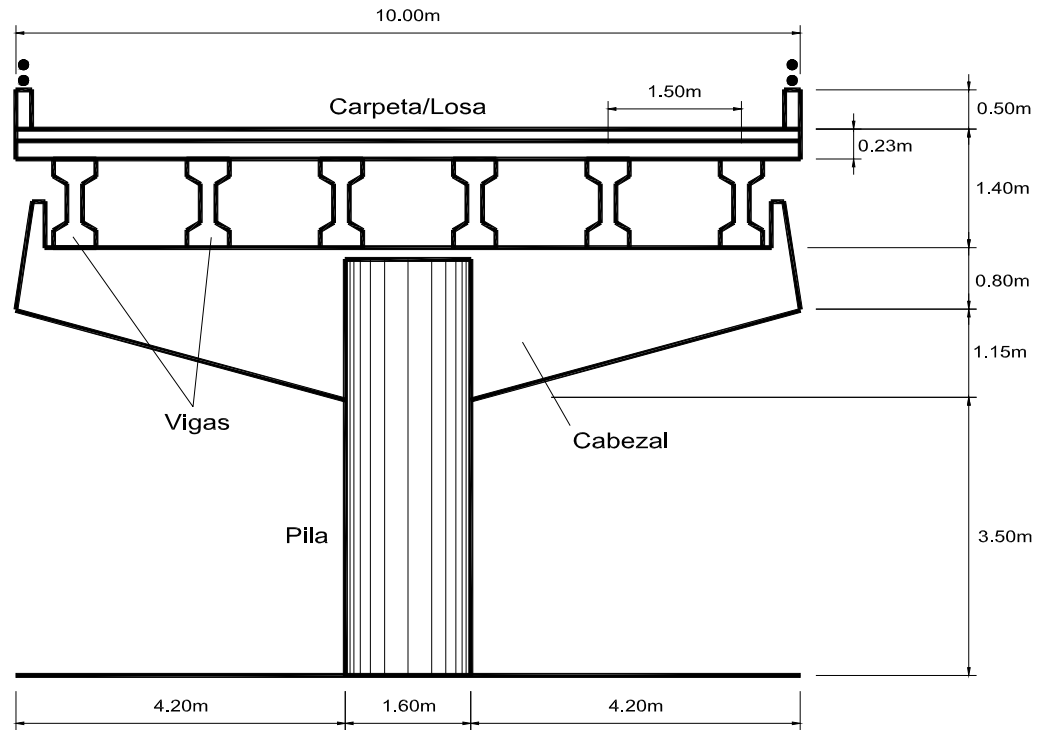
Croquis de la sección transversal en la pila intermedia.
